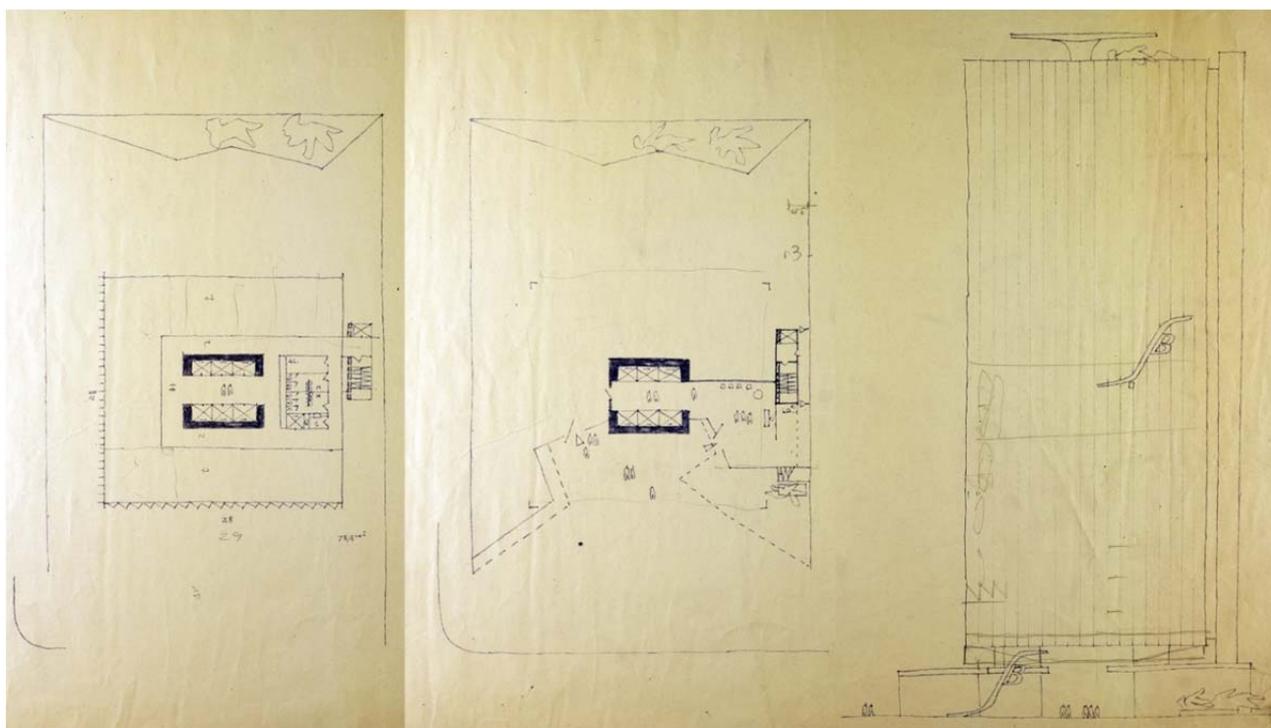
Plantas e elevação projeto sede do Banco Safra – segunda proposta
